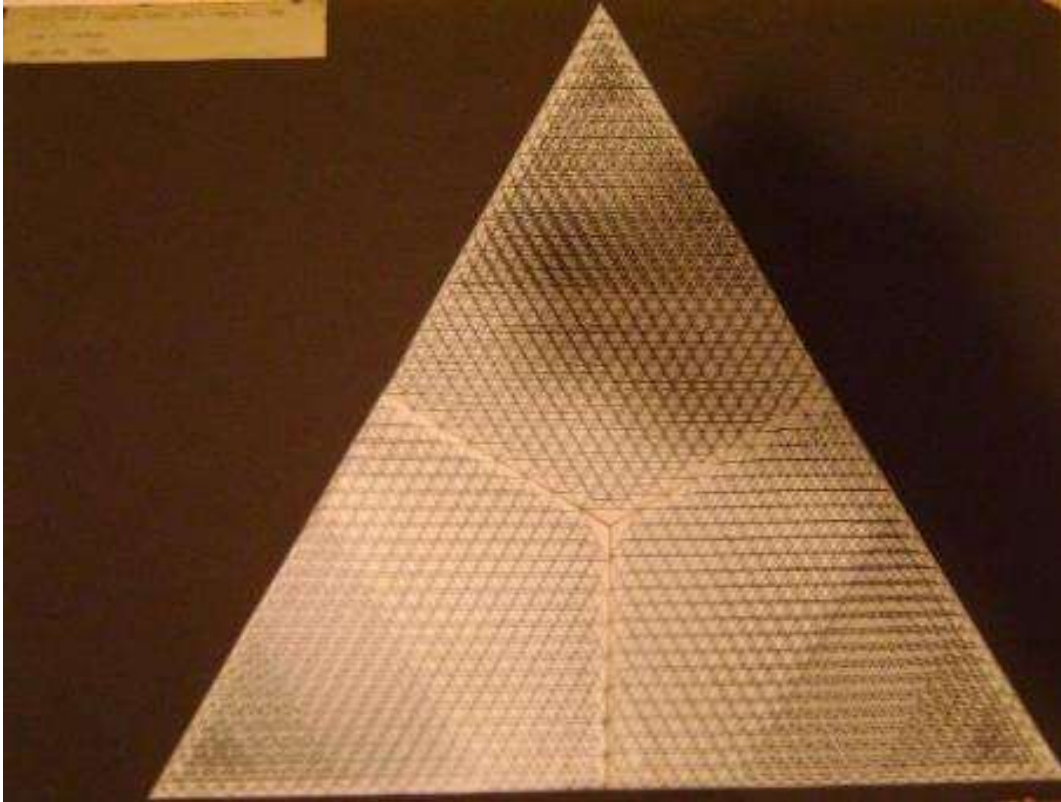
Detalle dibujo de la planta de la triada de las aulas de la Escuela Elemental de Bucks County P. A., dividida en tres fracciones estructurales.
